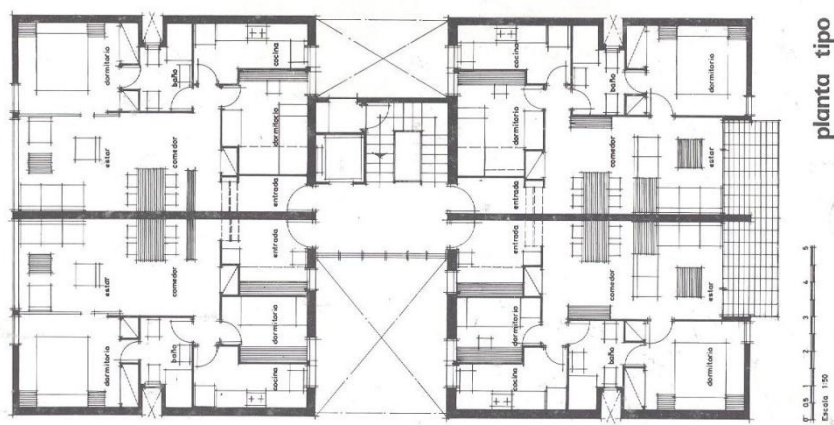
Edifício Mitre, Pavimento Tipo Fonte: Google imagens.
